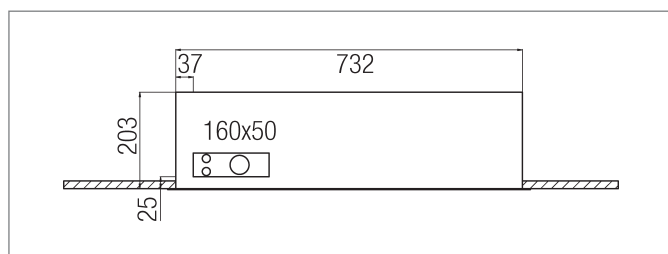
Sezione trasversale del telaio di installazione con apertura
